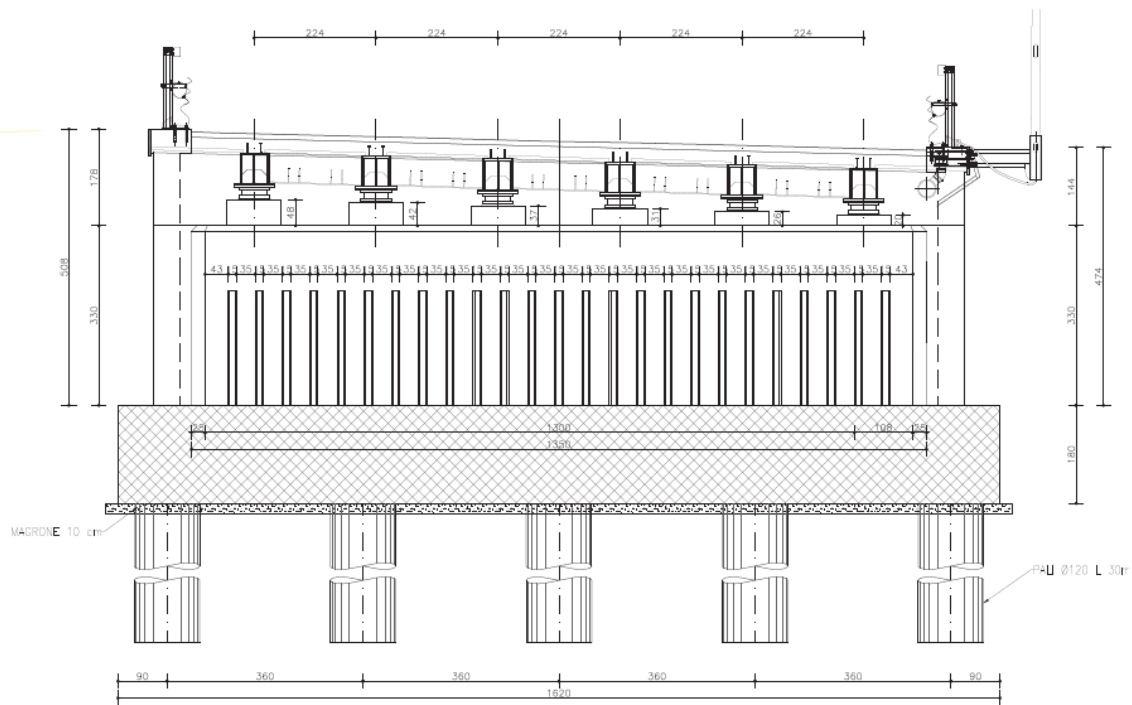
viste e sezioni principali – sezione trasversale in spalla
